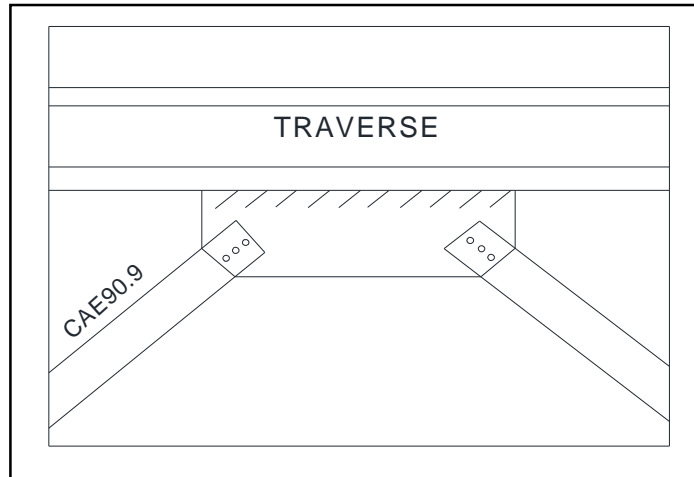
Exemple d'assemblage des diagonales de poutre au vent avec la traverse.
